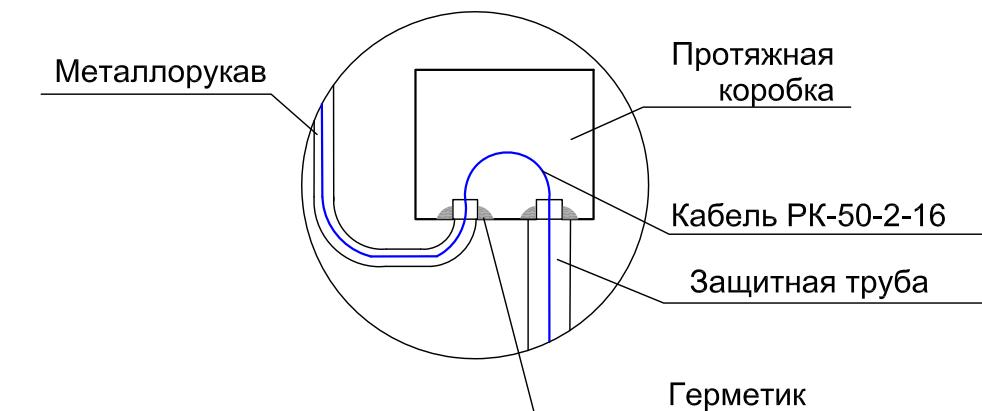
Прокладка соединительного кабеля через протяжную коробку
